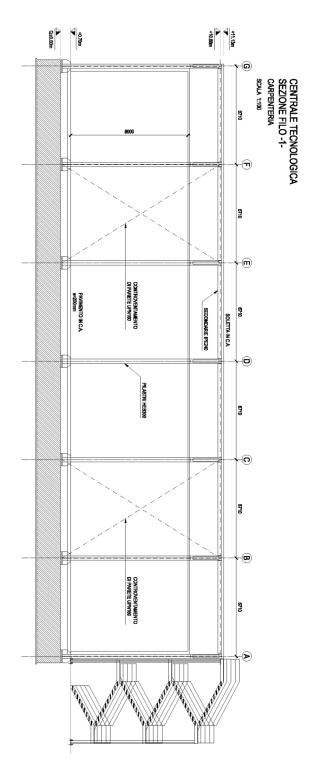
Sezione longitudinale tipo struttura di elevazione
